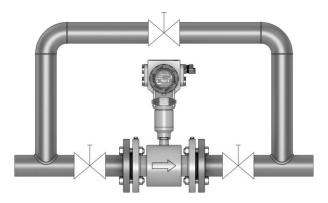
Монтаж расходомера (в узел байпаса)
